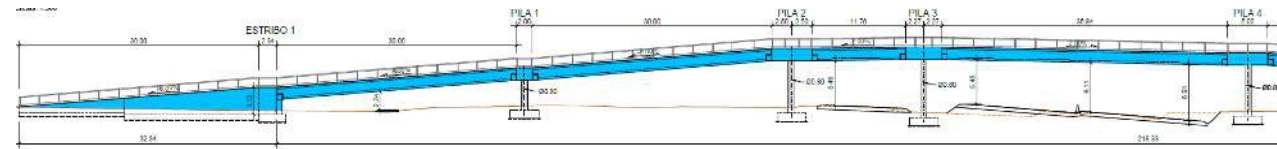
Sección longitudinal en una de las rampas y en el cruce con los ejes viarios. Pasarela P-1
